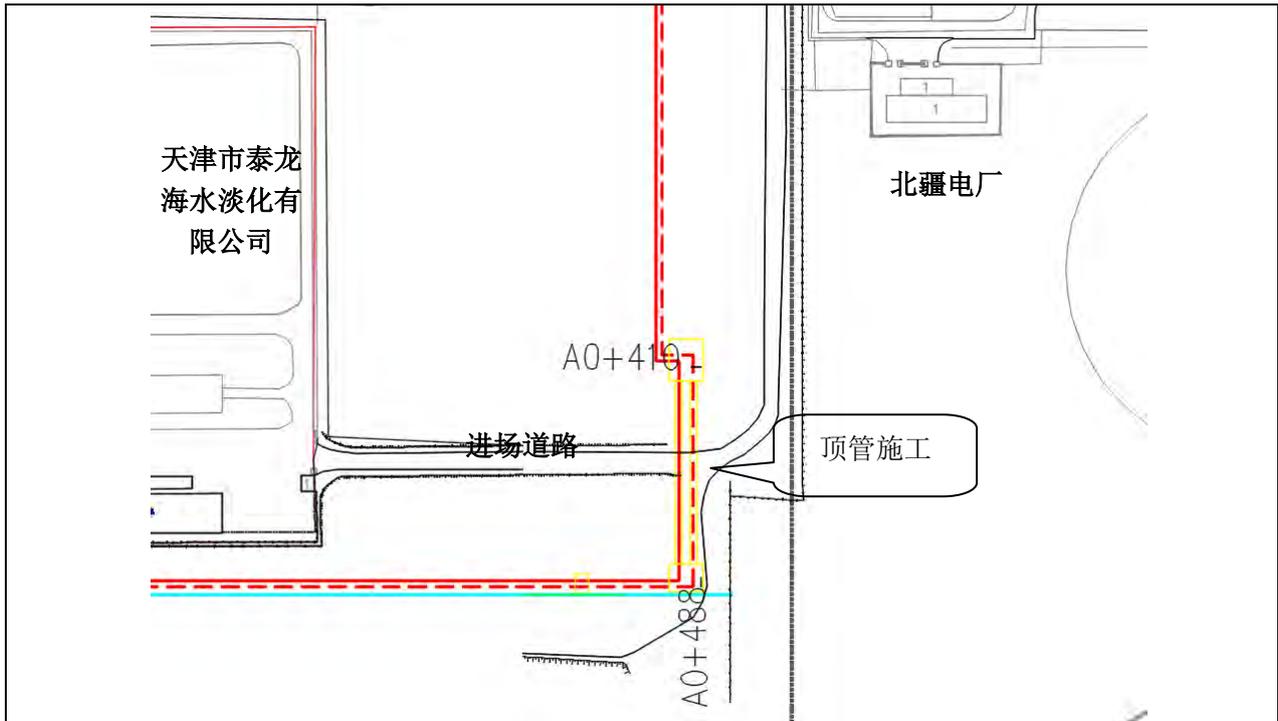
桩号 A0+410-A0+488 热力管线变更平面图
